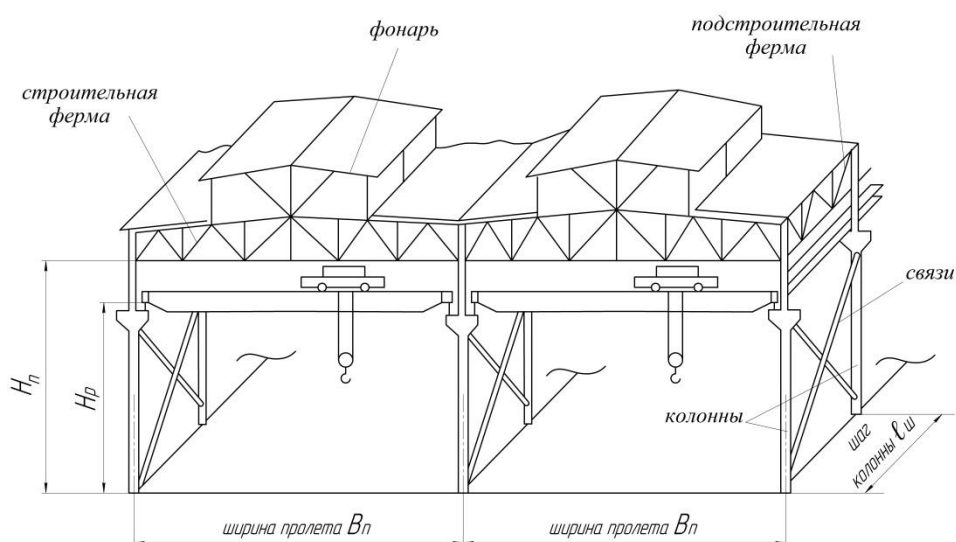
Основные элементы строительных конструкций промышленного здания
